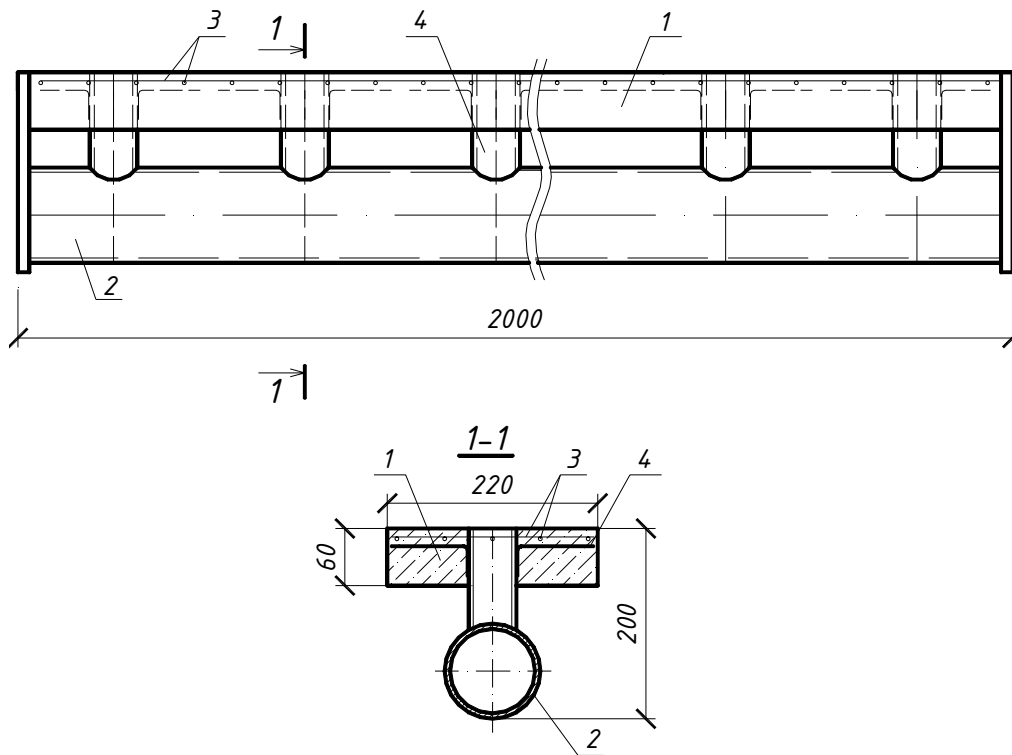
Сталезалізобетонна балка з армуванням трубою
